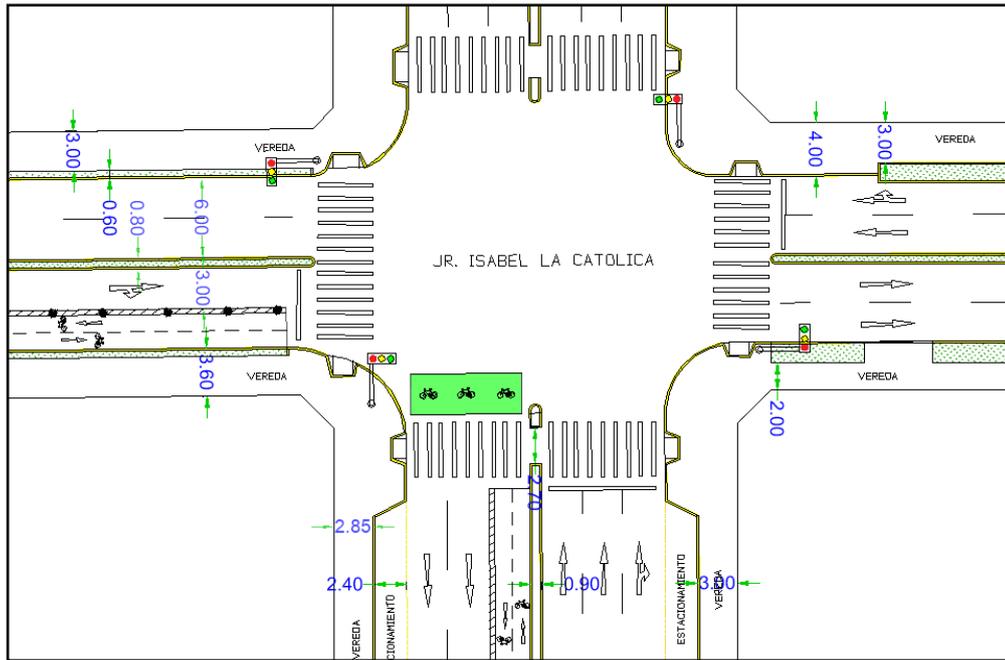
Vista en planta de la situación propuesta en intersección de Av. Isabel La Católica.
